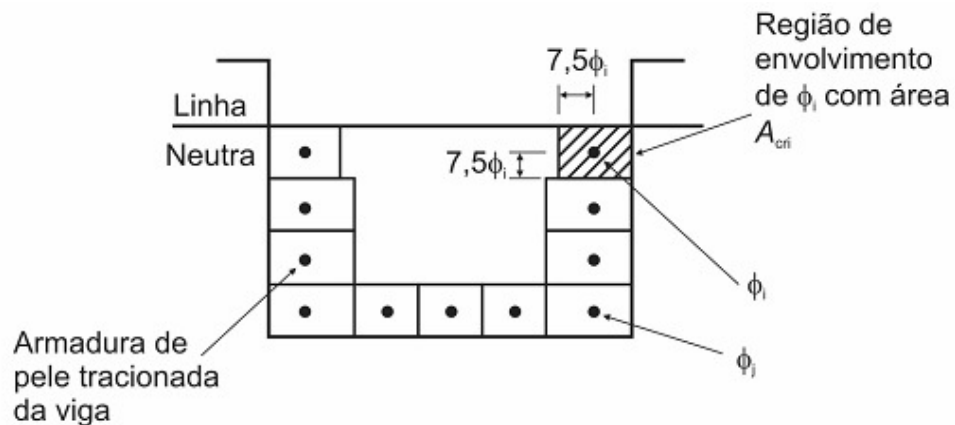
Concreto de envolvimento da armadura – NBR 6118:2003
